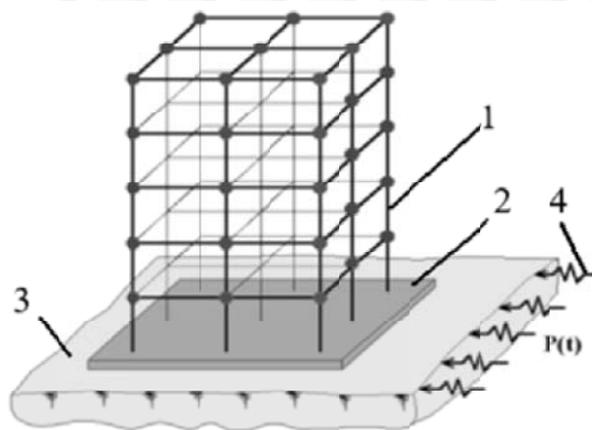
Пространственная расчетная схема 5-ти этажного каркасного здания на ПФП при оценке эффективности сейсмоизоляции в виде скользящего слоя: 1 – рамный каркас здания; 2 – фундаментная плита; 3 – массив грунта; 4 – горизонтальная вибрационная нагрузка
